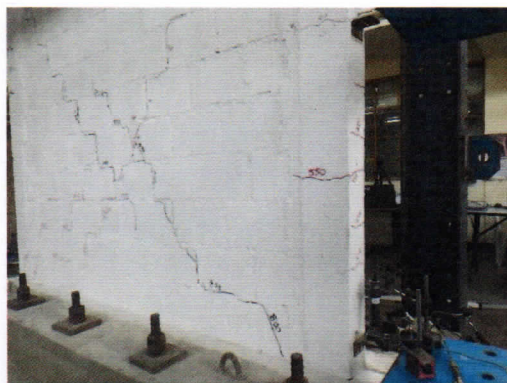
Aparición de grietas por flexión en la parte media e inferior de la columna Este para una distorsión de 1/550.
